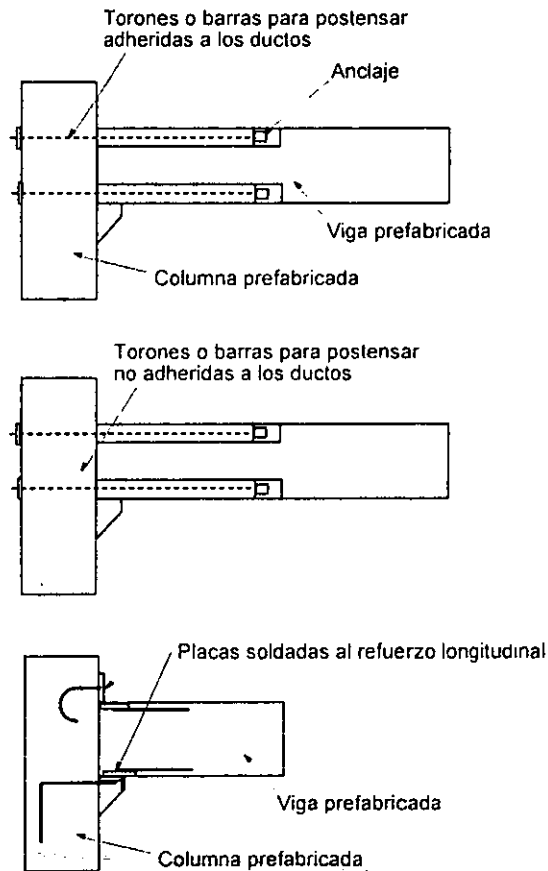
Tipos de conexiones viga–columna ensayadas en Universidad de Minnesota
